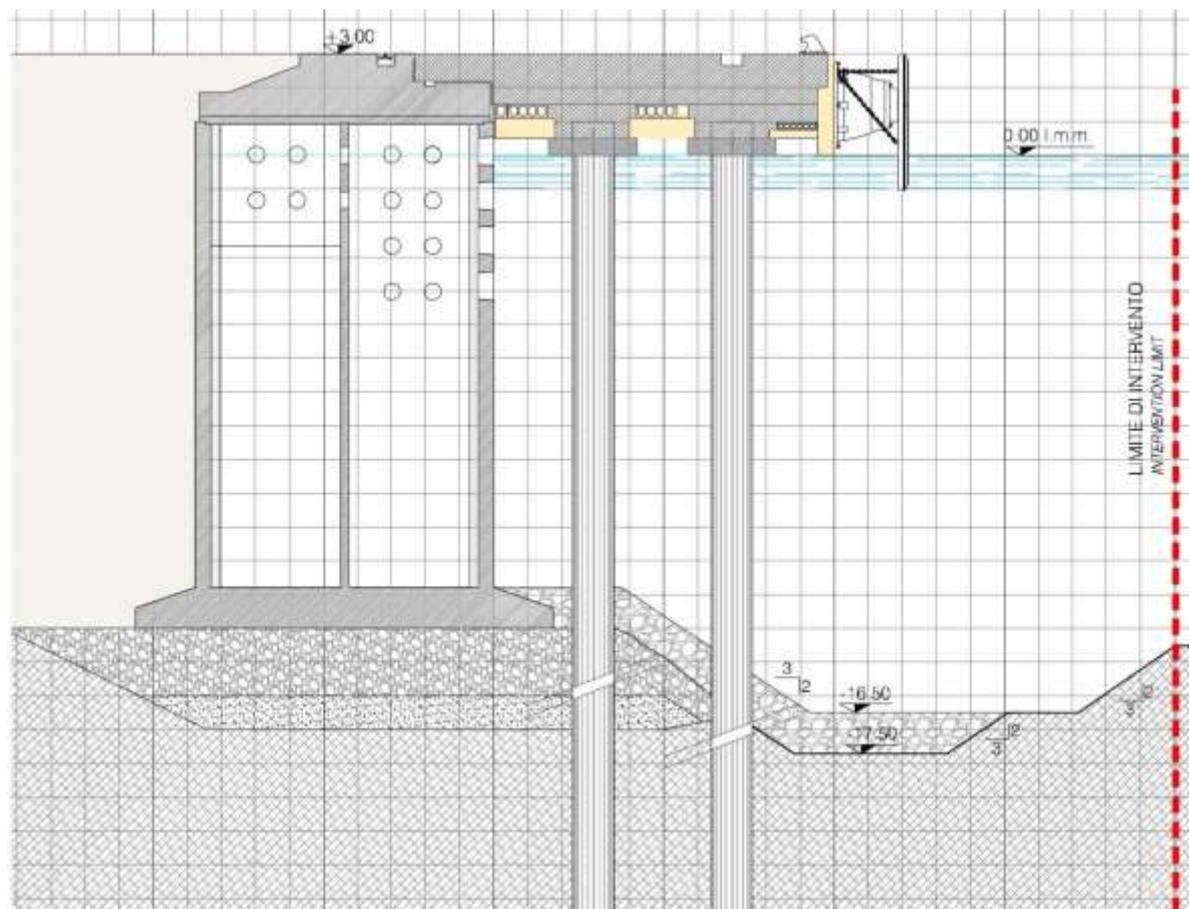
Sezione tipo dell'intervento di consolidamento della banchina
